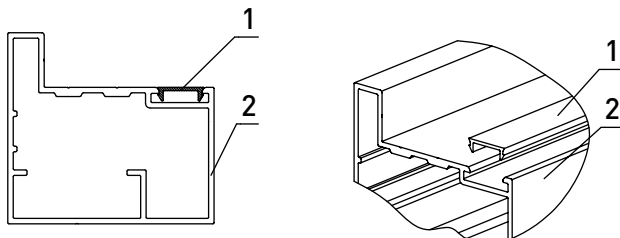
Установка уплотнителя FLGU.400.0718:
